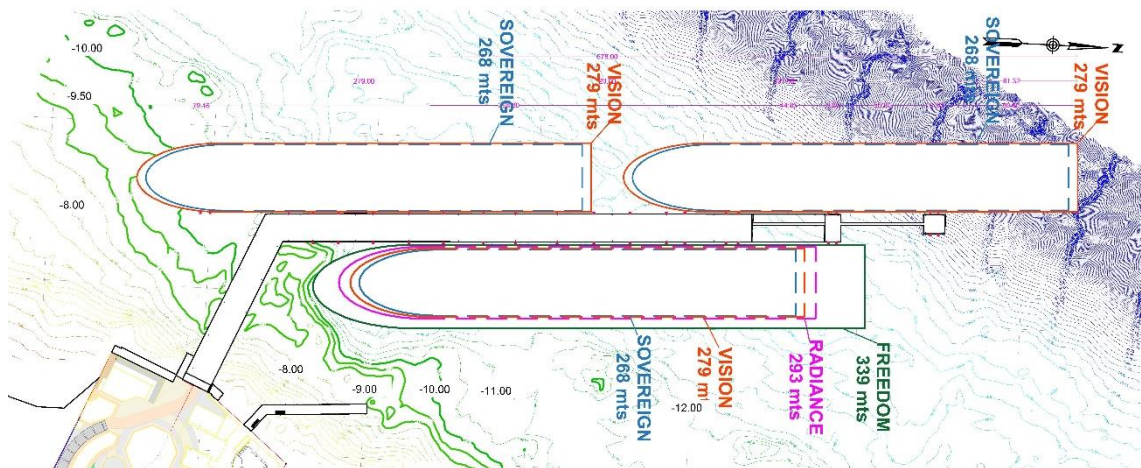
Vista en planta del estado actual de operación del muelle con tres posiciones.
